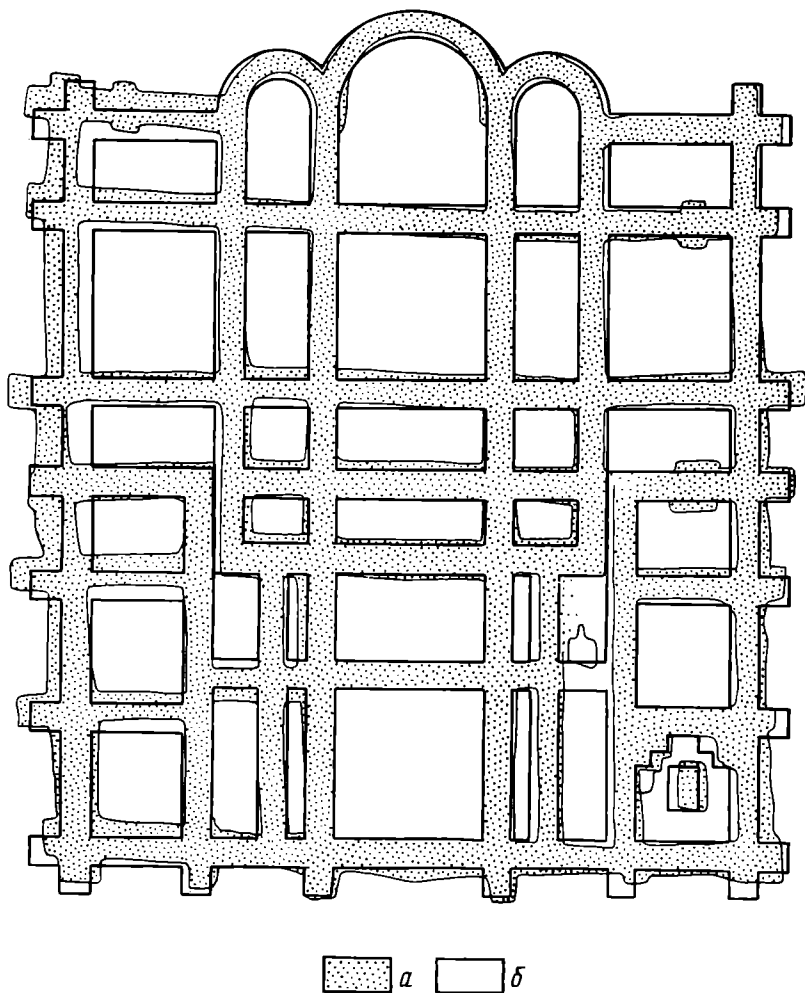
Сопоставление сохранившихся и реконструируемых планов фундаментов Десятичной церкви: *a* — план фундаментов, вскрытых археологическими раскопками; *b* — реконструируемый план фундаментов
